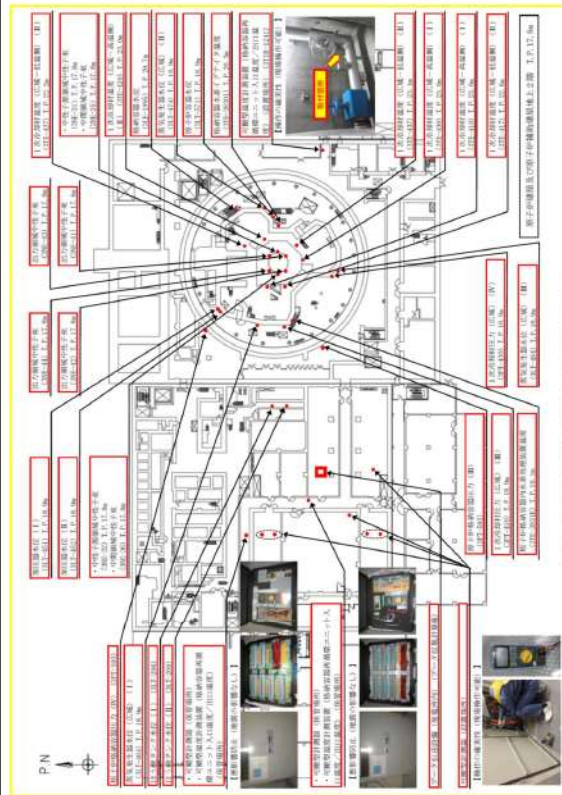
配置図 (原子炉建屋及び原子炉補助建屋地上2階)
